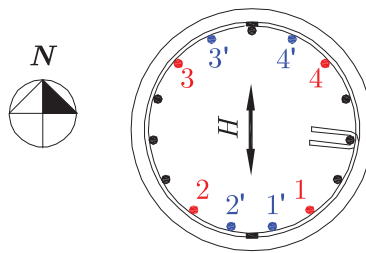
Jauges de déformation sur les barres d'acier longitudinales.
